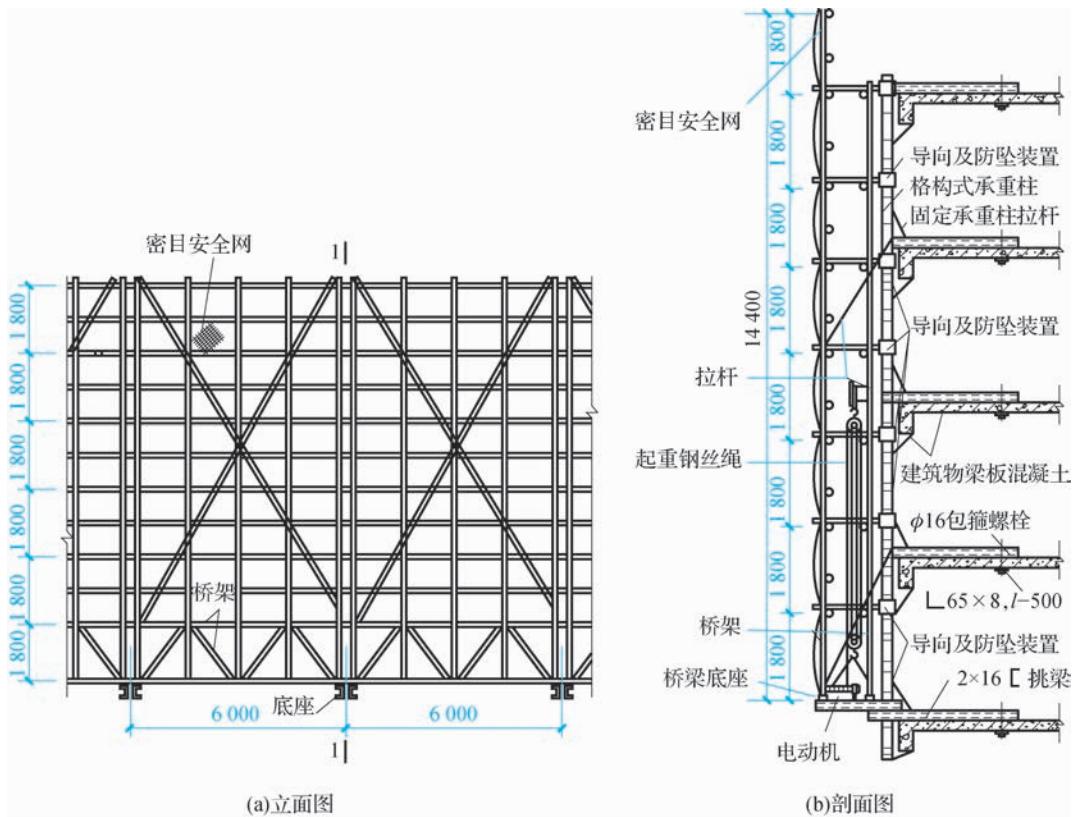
附着升降脚手架立面、剖面图(单位:mm)
